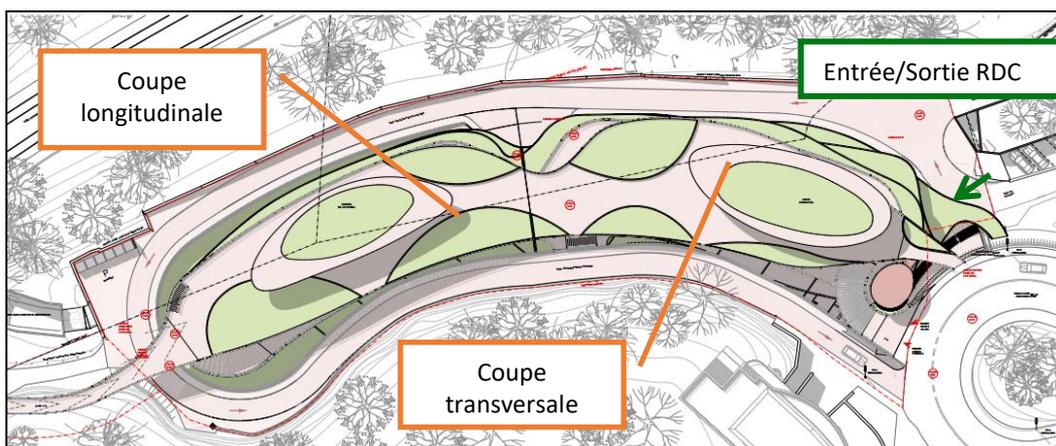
Plan des aménagements paysagers : vue toiture (Source : Atelier du Pont, 2021)
